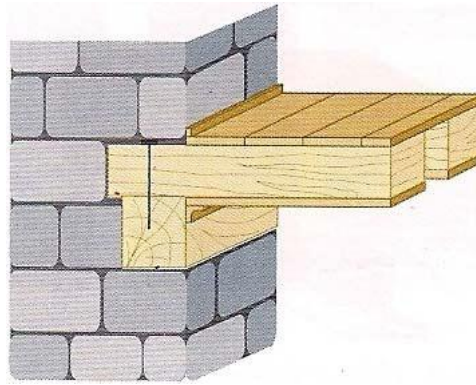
Ligação do pavimento à parede de alvenaria com frechal existente na parede [1]
